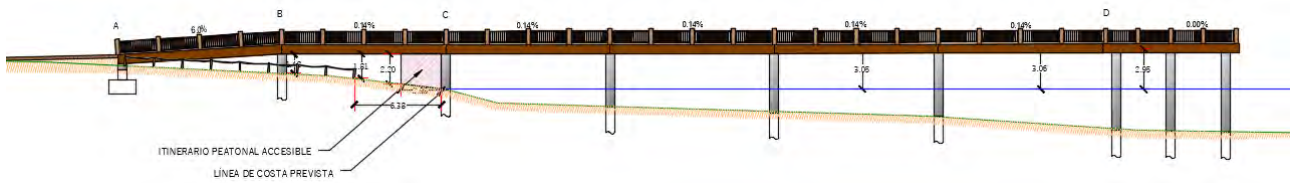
Captura del Plano 02 Perfil longitudinal Alternativa 3 (Anexo 1 Planos).
